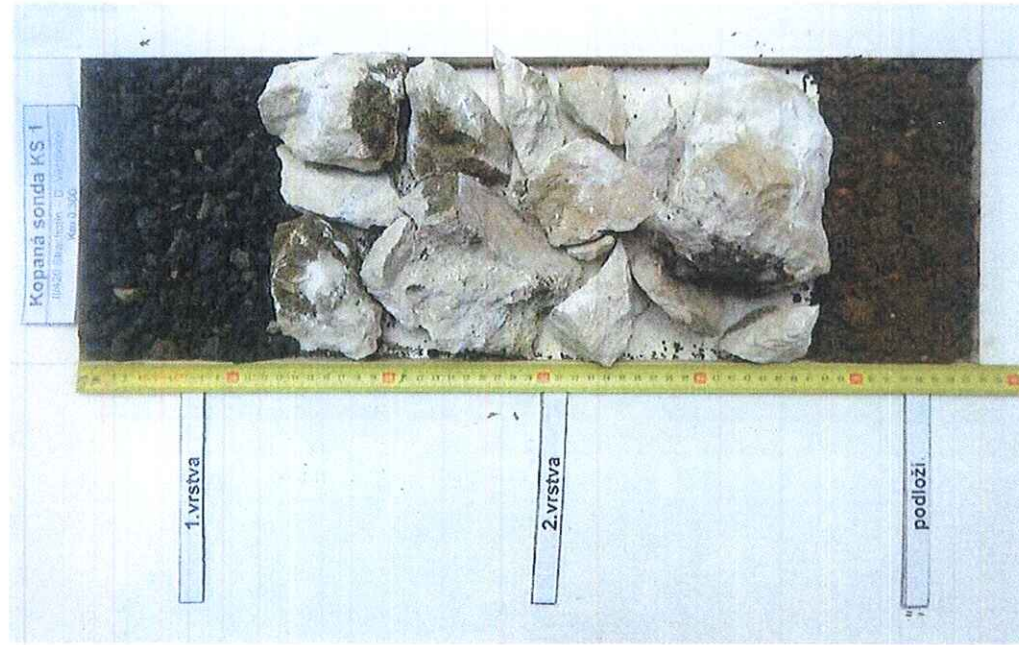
a č. 2 - Kopaná sonda KS 1
